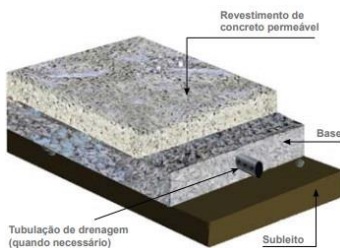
Seção típica de pavimento de concreto permeável, PR-3 Conceitos e Requisitos para Pavimentos de Concreto Permeável, 2016.
